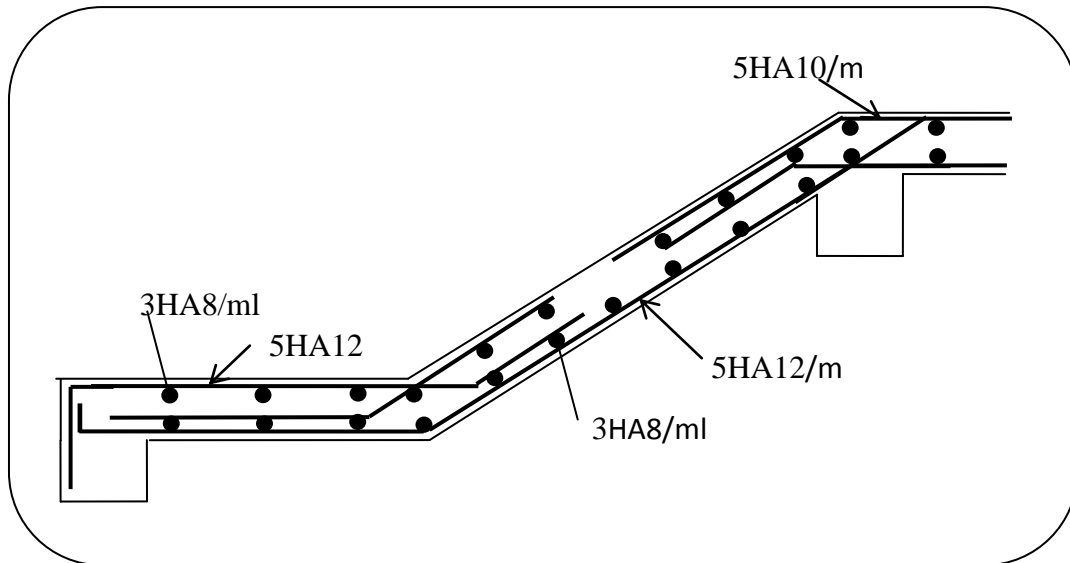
Schéma de ferrailage de l'escalier principal
